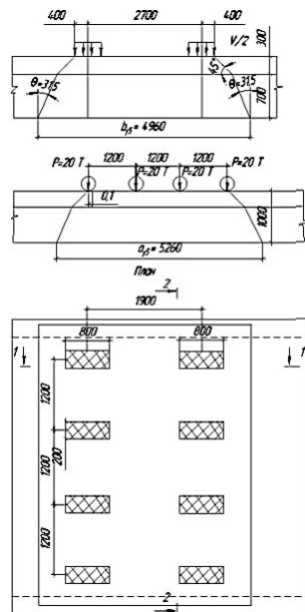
Распределение вертикальной временной нагрузки на плиты перекрытия по схеме НК-80
